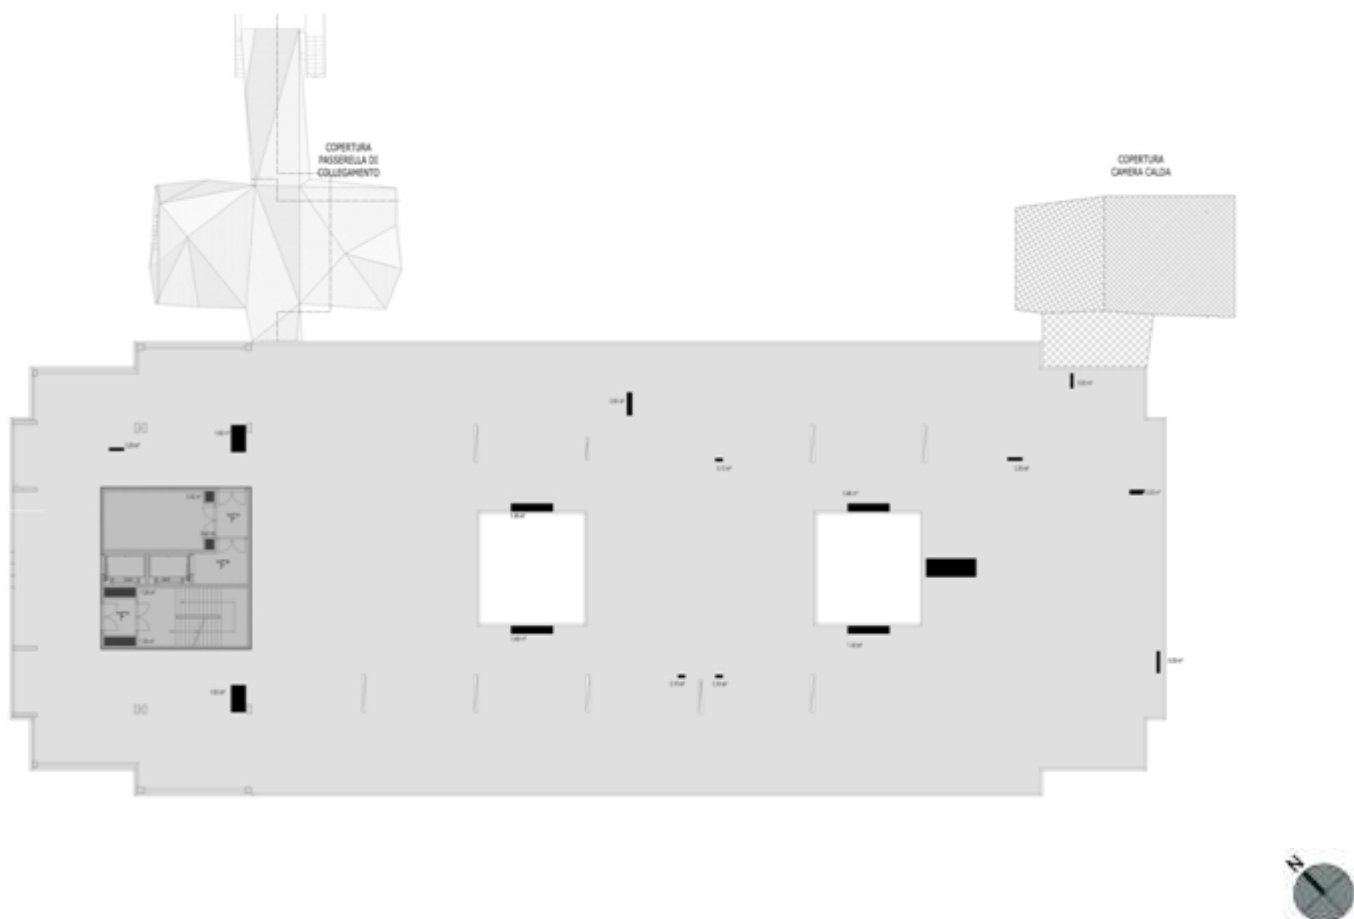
Planimetria Piano Copertura - livello +17,50.
